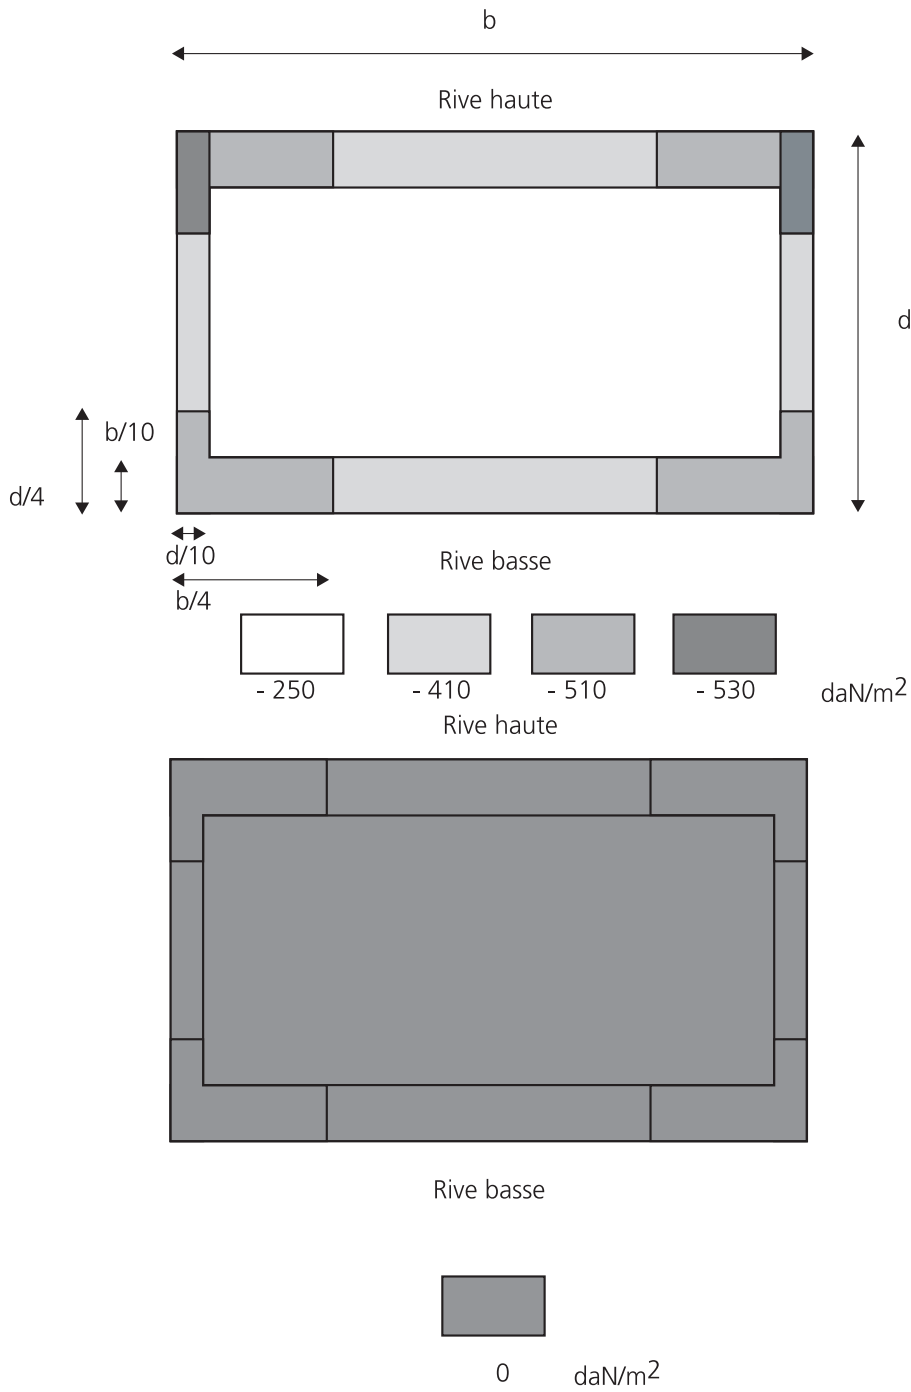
Charges forfaitaires d’arrachement et d’écrasement sur une toiture à un versant de pente = 5° - $h \leq 10$ m
